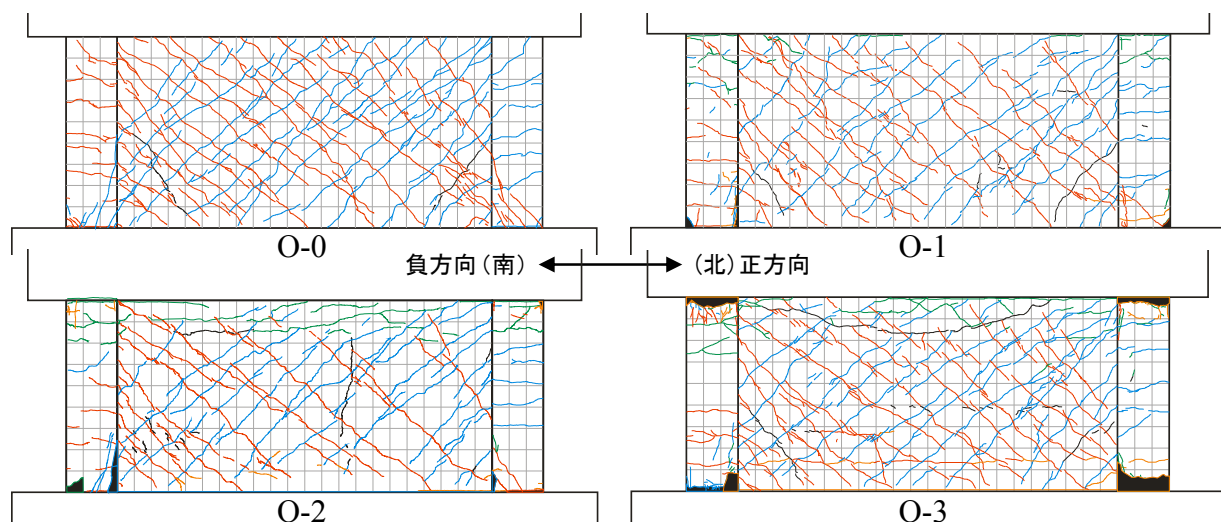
1.0%サイクル終了時東面ひび割れ図
